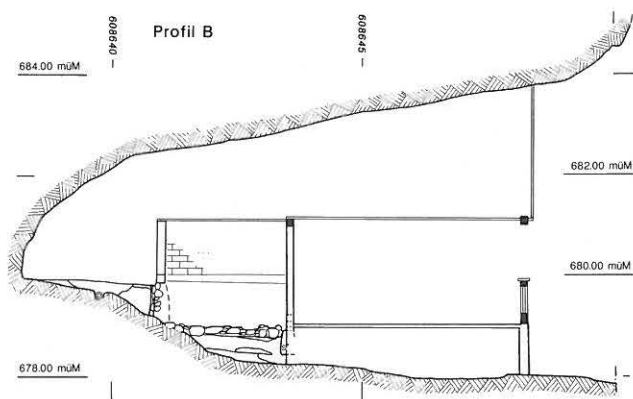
Krauchthal, Äusseres Fluhhäuschen. Schnitt B. M. 1:150. Lage s. Grundrissplan.
